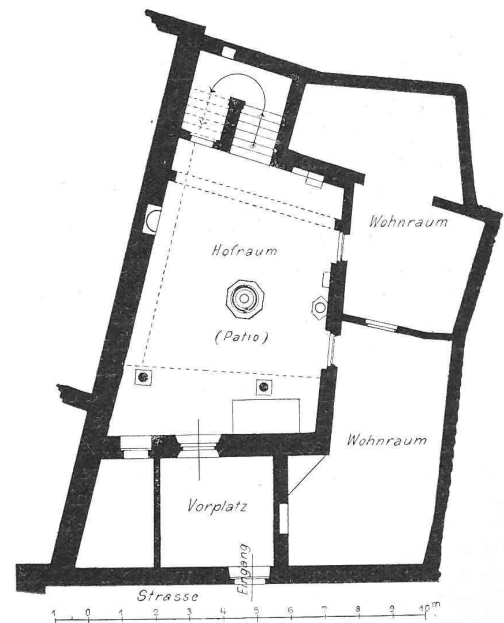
Grundriss eines maurischen Hauses in Toledo. — 1:200.
